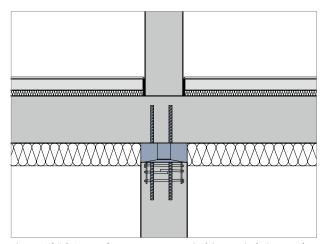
Schöck Sconnex® type P pour poteau intérieurs et isolation sous la dalle
